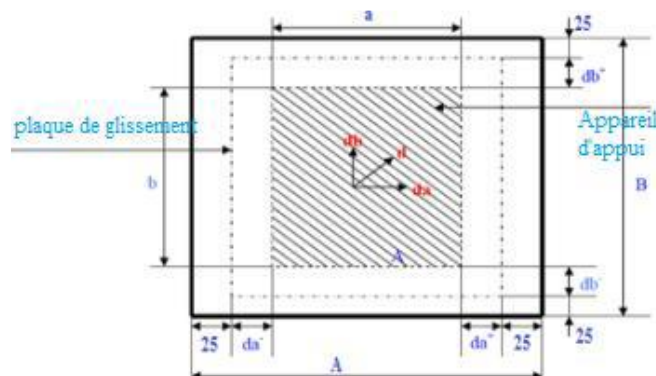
Dimensions en plan du dé d'appui.
